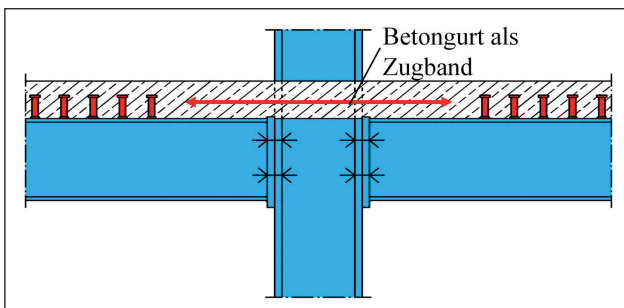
Verbundknoten mit duktiler Bewehrung als Zugband im Betongurt
